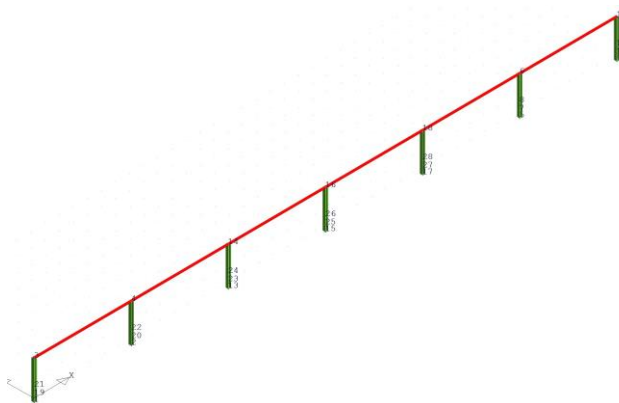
Vista assonometrica telaio in area ad attività zootecnica
